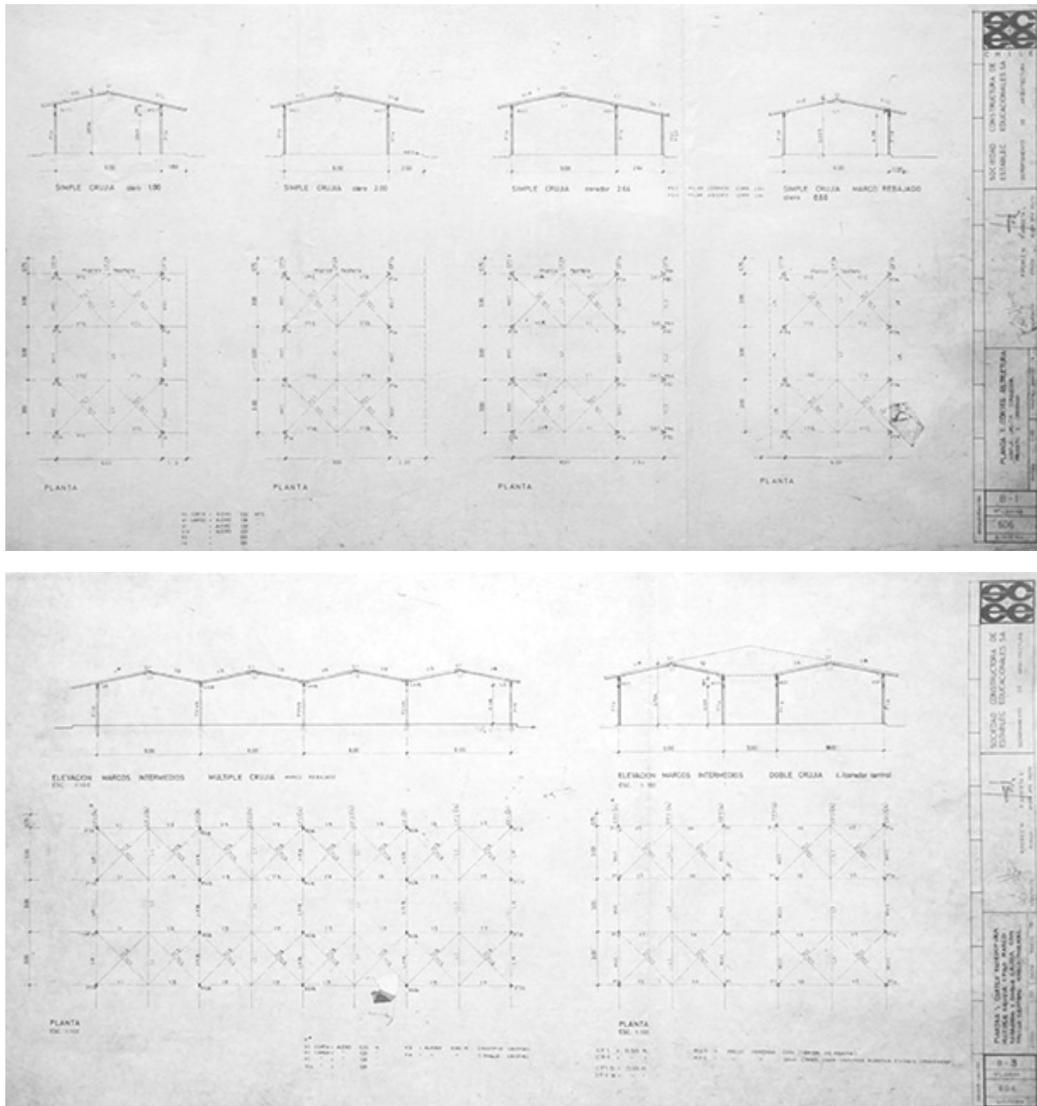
Escuelas construidas con sistemas constructivos de la familia MC: 401-f de 1963, 606 de 1969, 720 de 1969 y 606 múltiple crujía de 1975.
